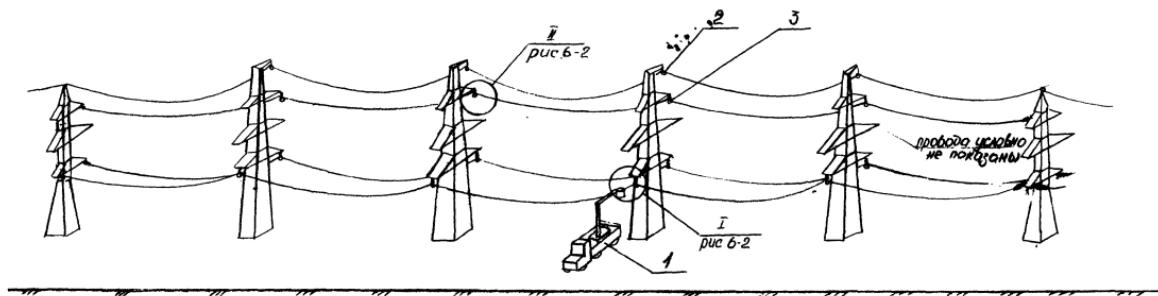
Перекладка проводов и заземляющего троса из раскаточных роликов в зонами
